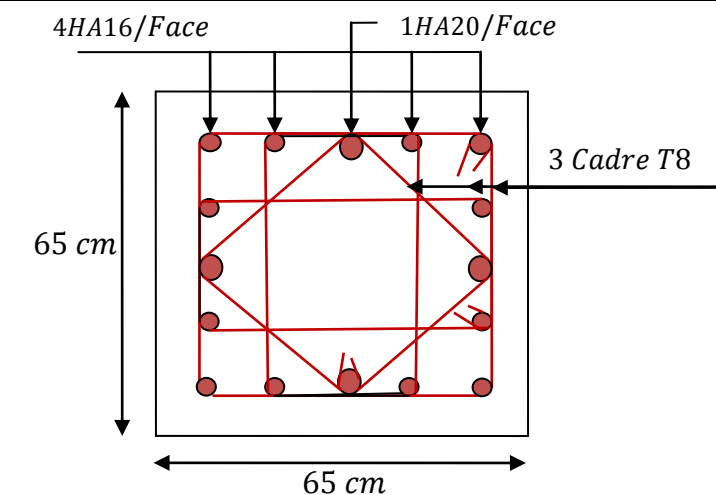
Schéma de principe de ferrailage et réduction des sections des poteaux
